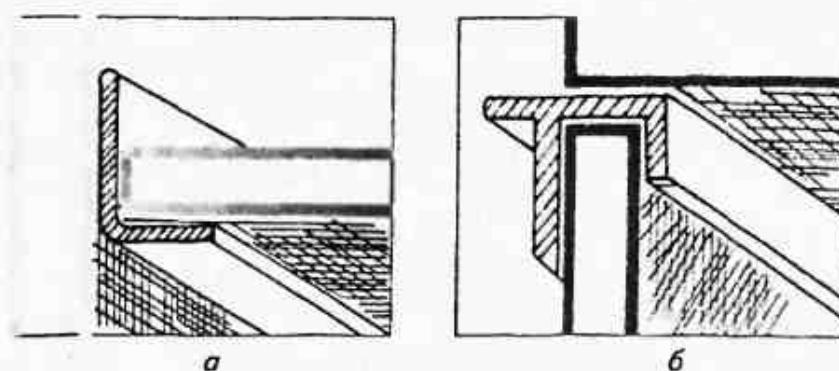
Сопряжение подвесного потолка со стеной: а — с монтажом пристенного уголка; б — с установкой пристенного плинтуса на стеновую панель
